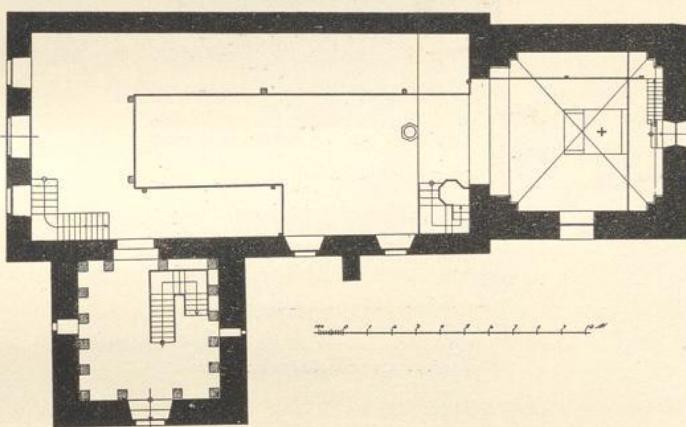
Kirche in Wilkenburg; Grundriss.
